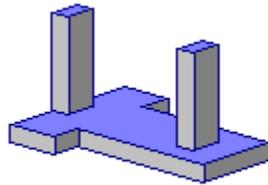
Zapata Combinada, Concreto, En Forma de "T", Colindante
